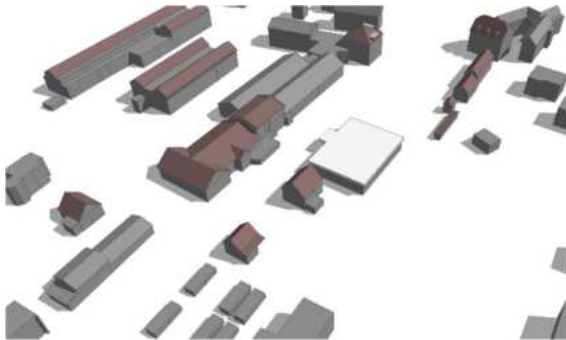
Baumassenstudie Ansicht Nord-West Bestand
